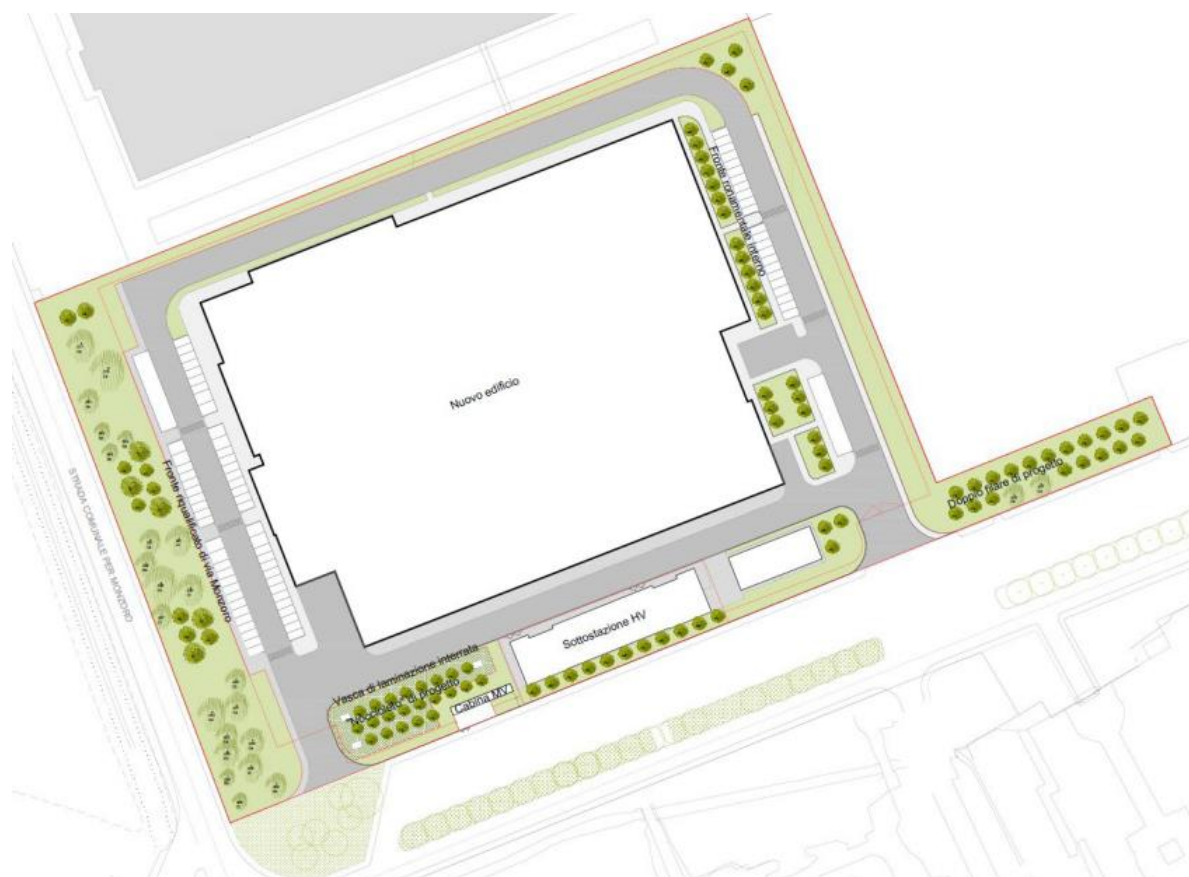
Stato di progetto Masterplan e aree verdi (Relazione preliminare integrazione progetto aree esterne)
